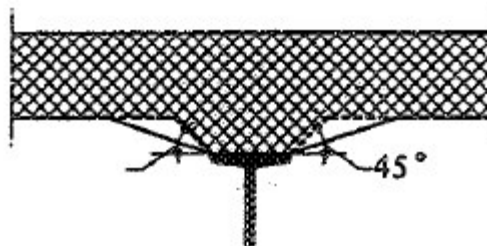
Tipos constructivos de la sección parcial de hormigón
